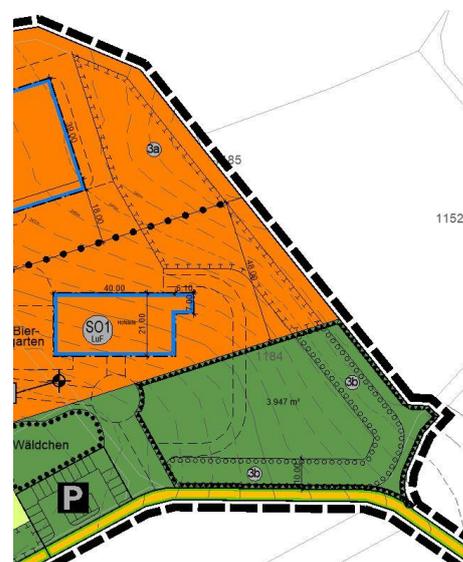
Bebauungsplan, 1. Änderung (neu)
